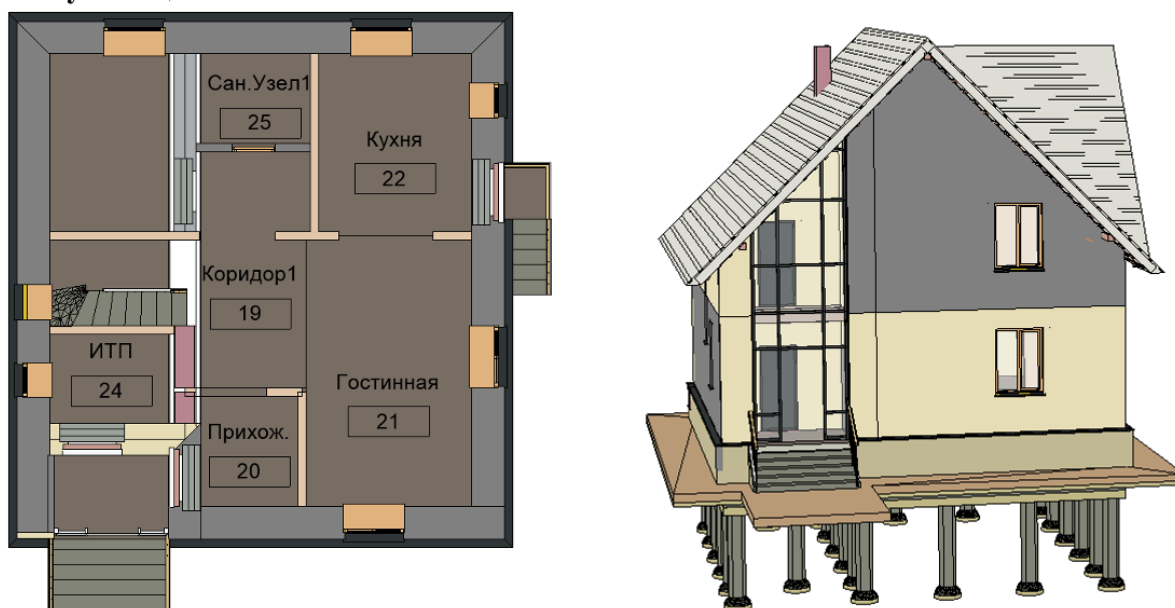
План 1-го этажа и 3D вид малоэтажного жилого здания
